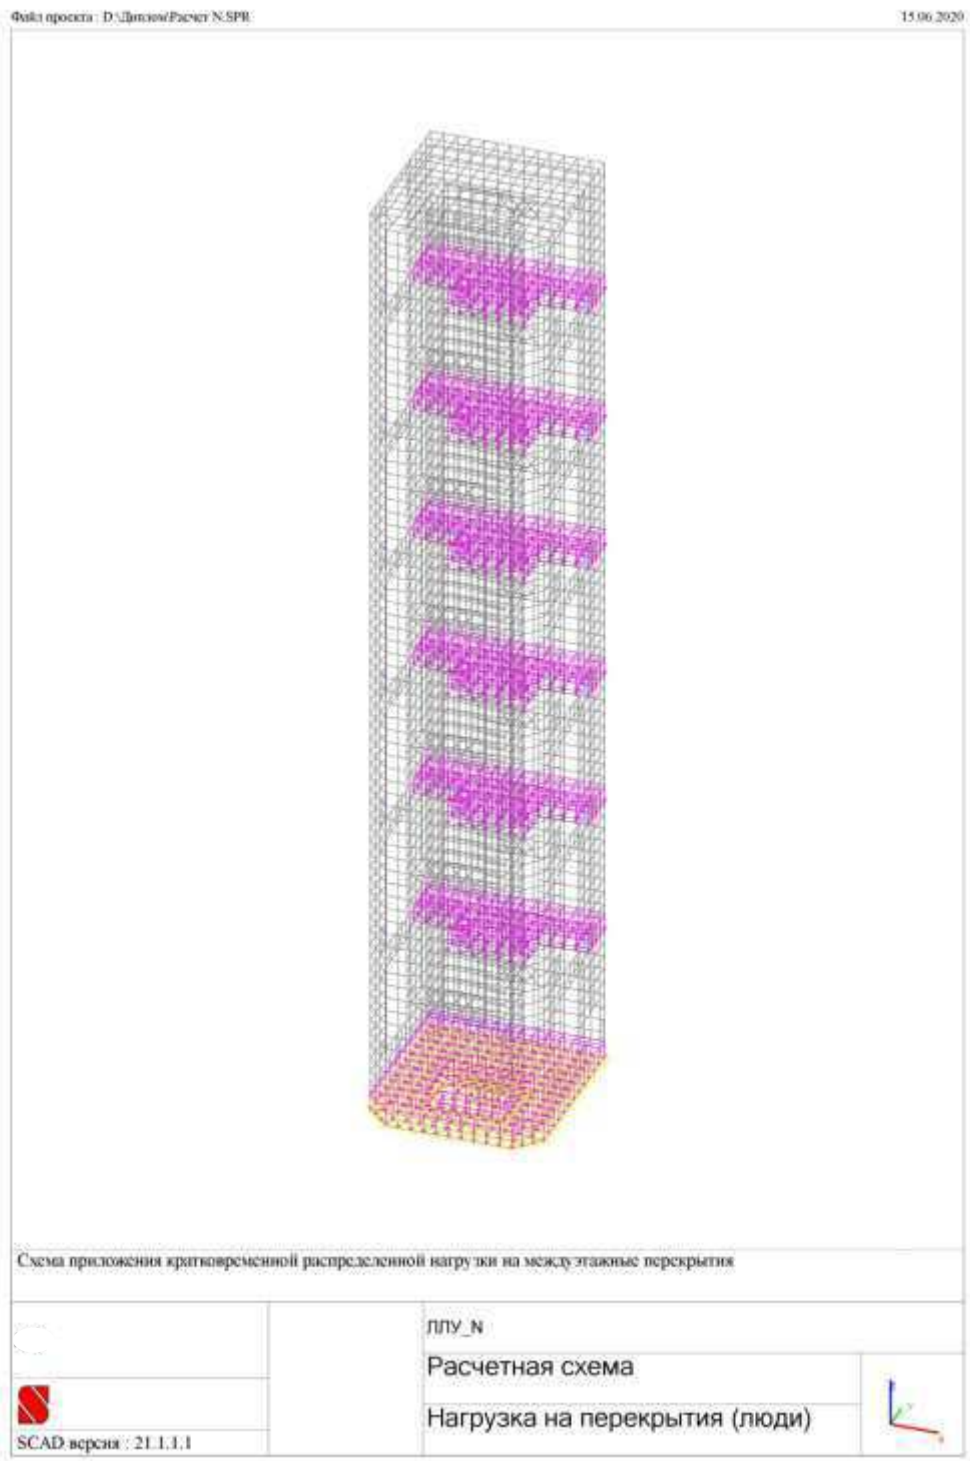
Нагрузка на междуэтажные перекрытия
